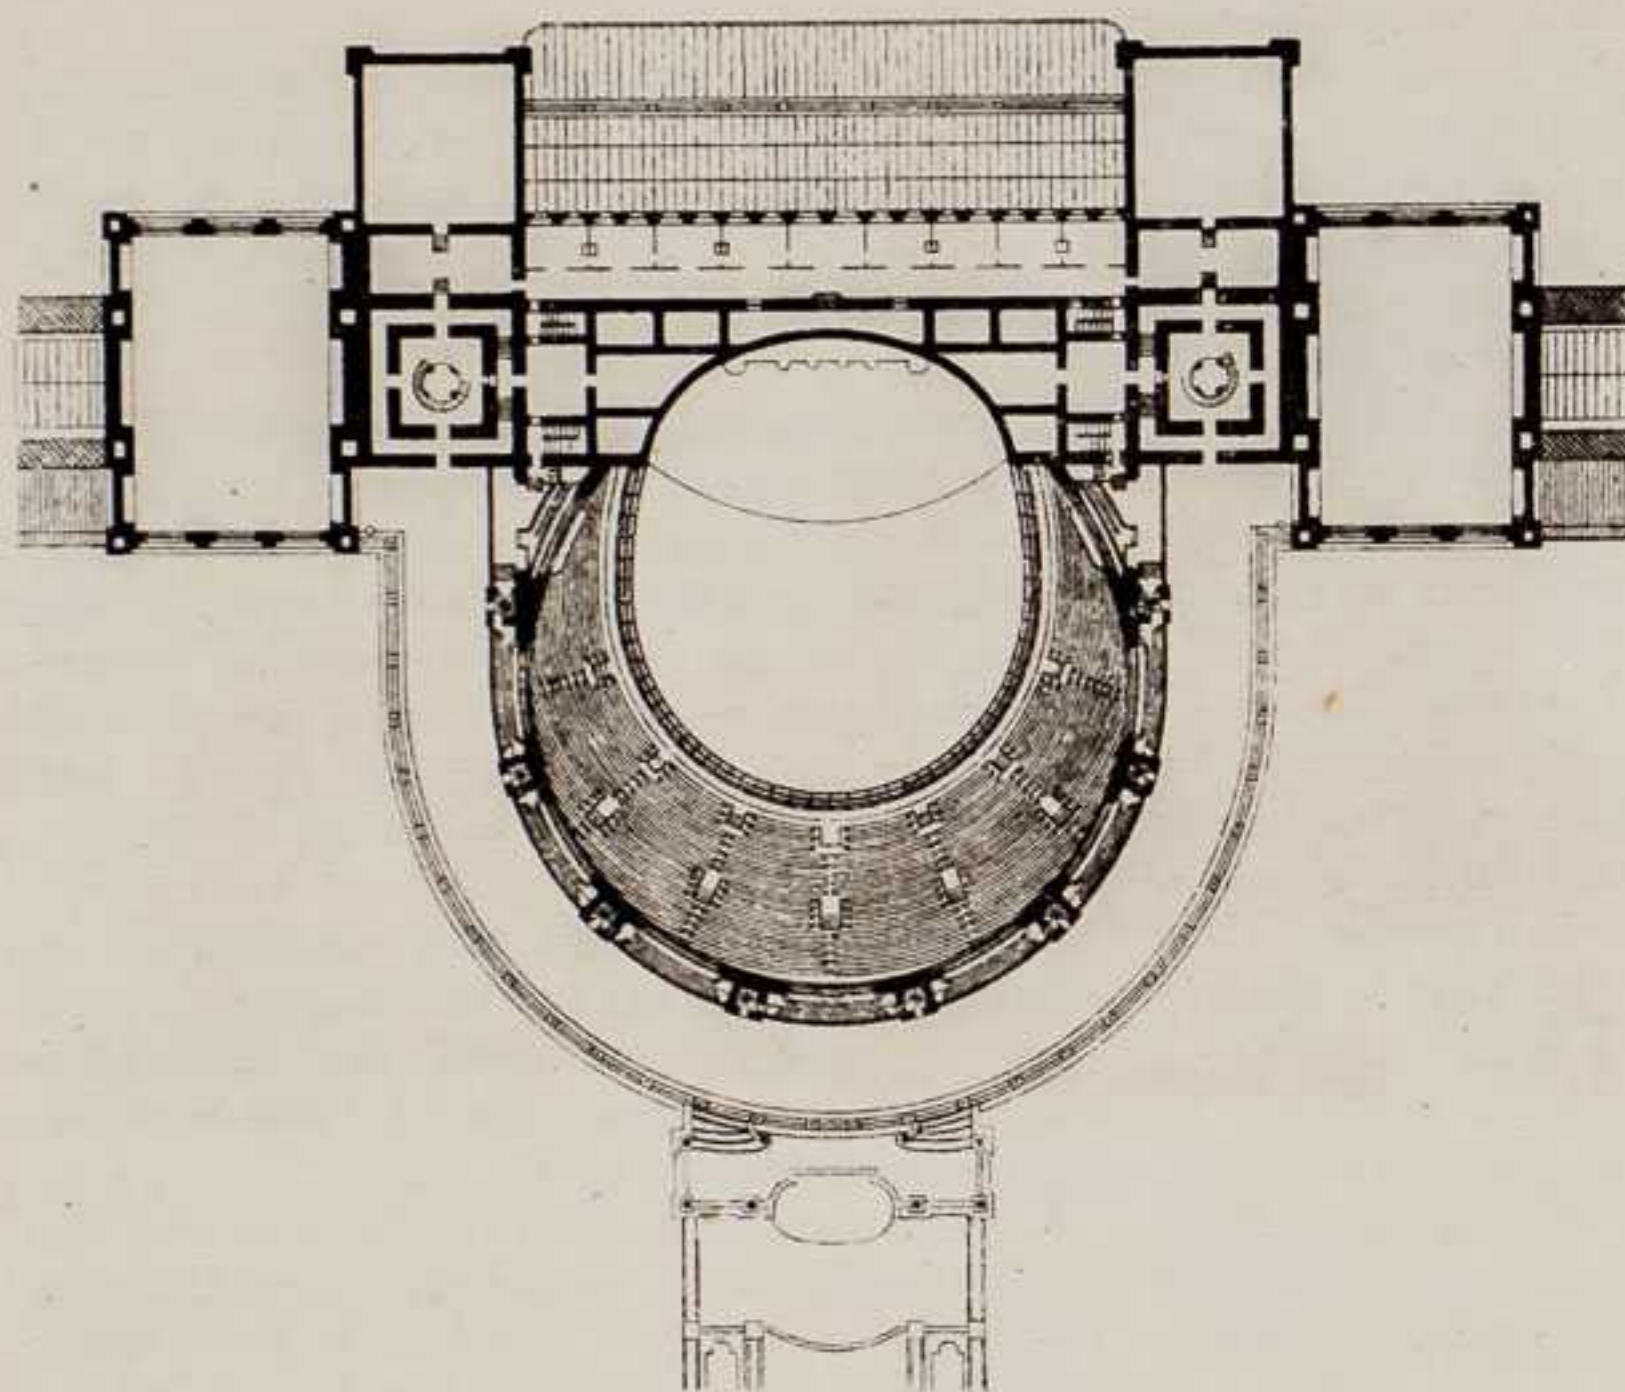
Il Trocadero. Sezione orizzontale (piano superiore). Scala di 0<sup>m</sup> 001 p. metro.
